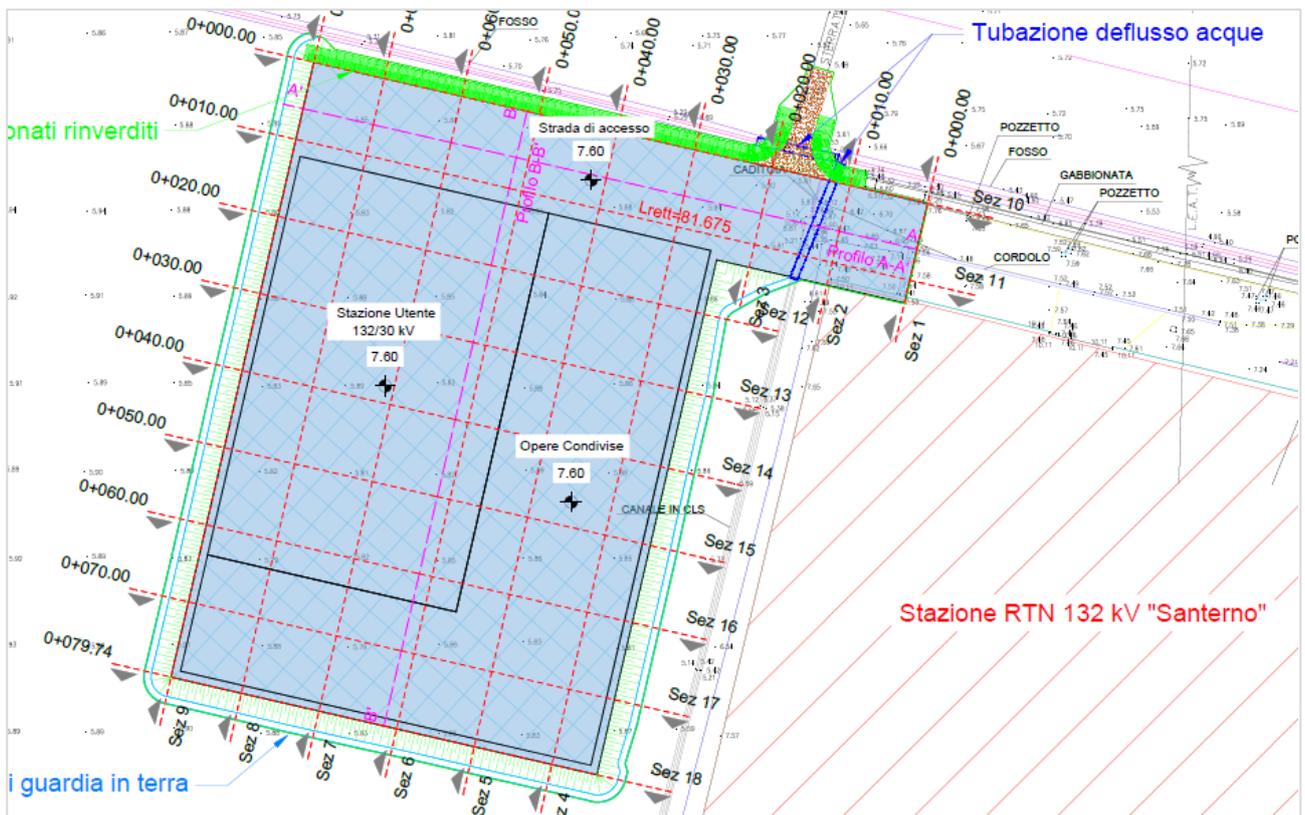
Progetto del piano finito del piazzale Stazione Utente e Opere Condivise
